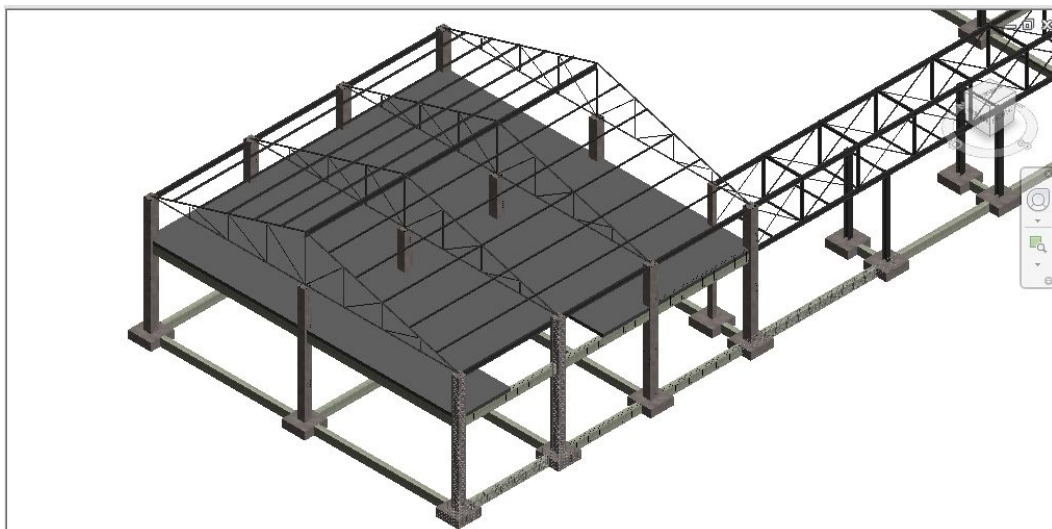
Suelo de hormigón en Planta 1 de Nave1.
